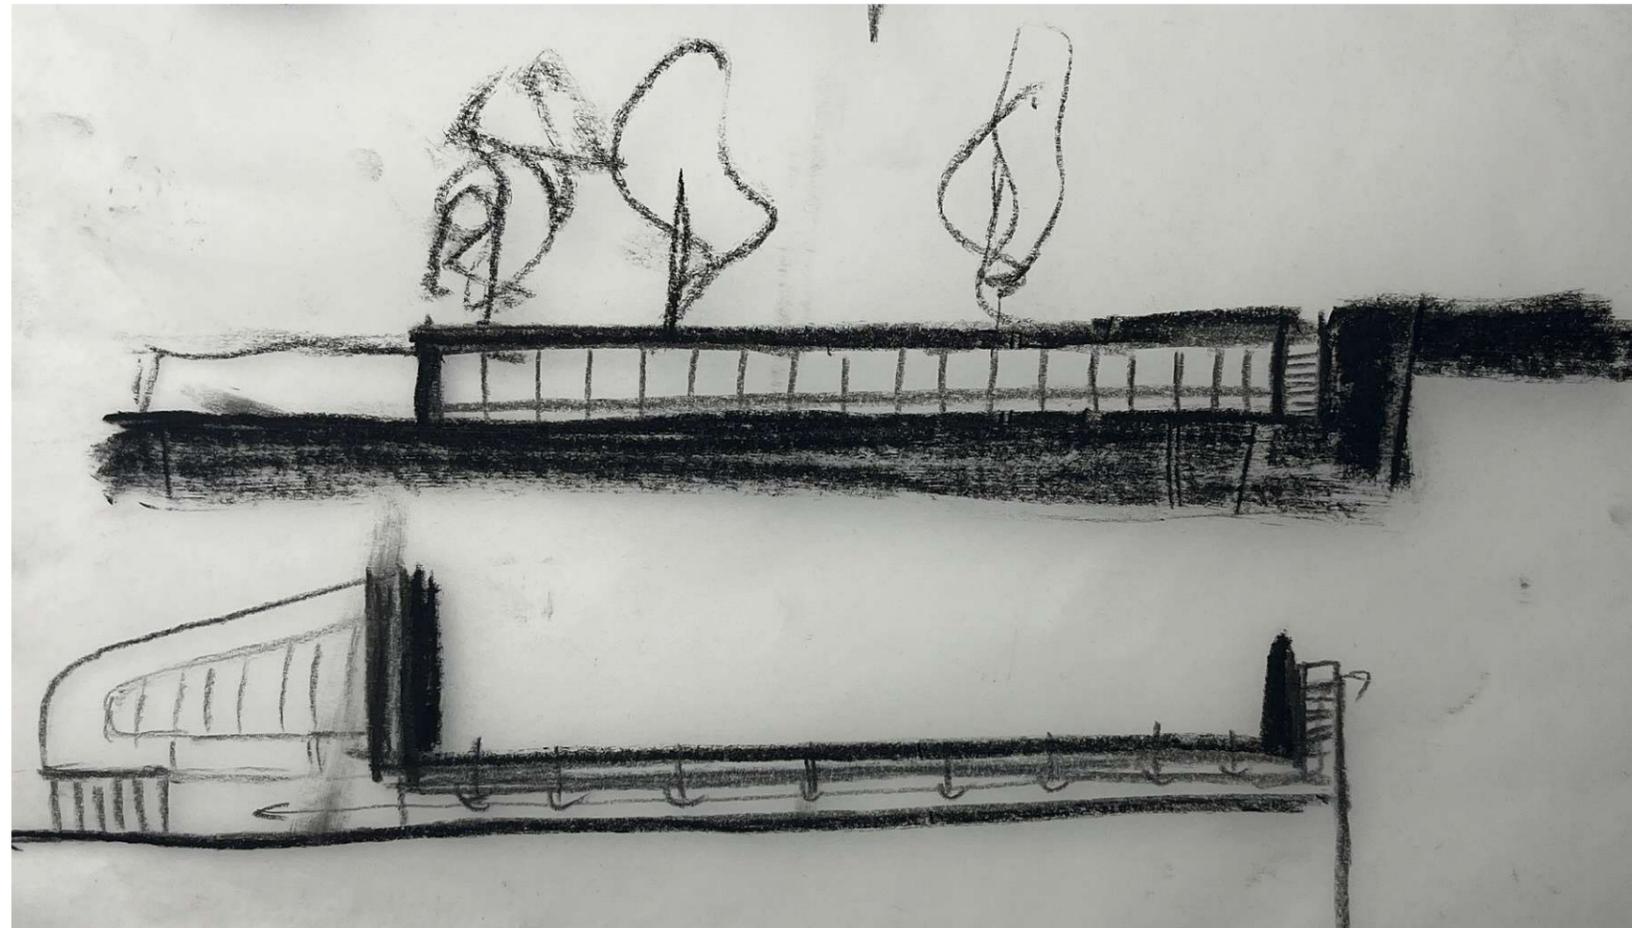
Konzeptskizze, Ansicht & Grundriss der Promenade, Autor, 2024
